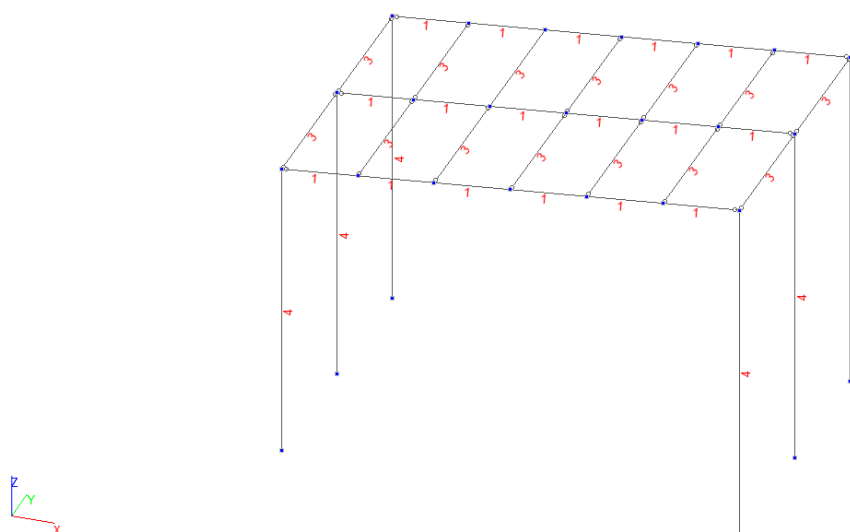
Расчётная схема балок покрытия здания (каркас)
